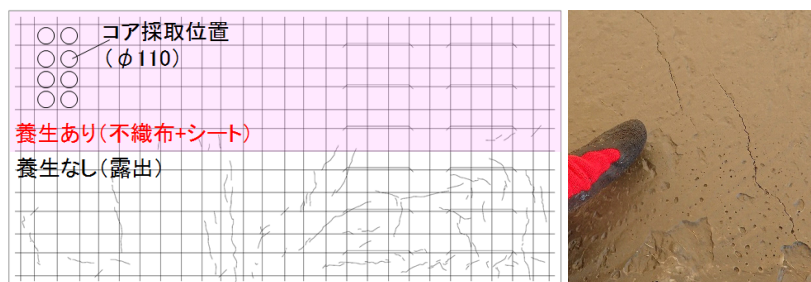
ひび割れ発生状況(床版No.2, 配合A) ※: No.1も同様
